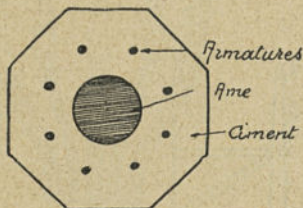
Section d'un poteau en béton armé avec âme en bois (Bourgeat).
